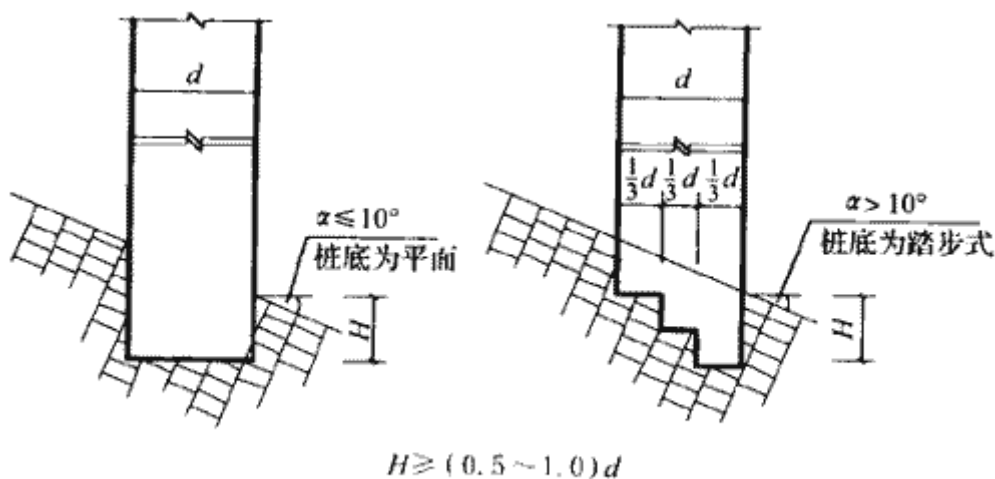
基岩顶面为斜面时桩端做法示意
